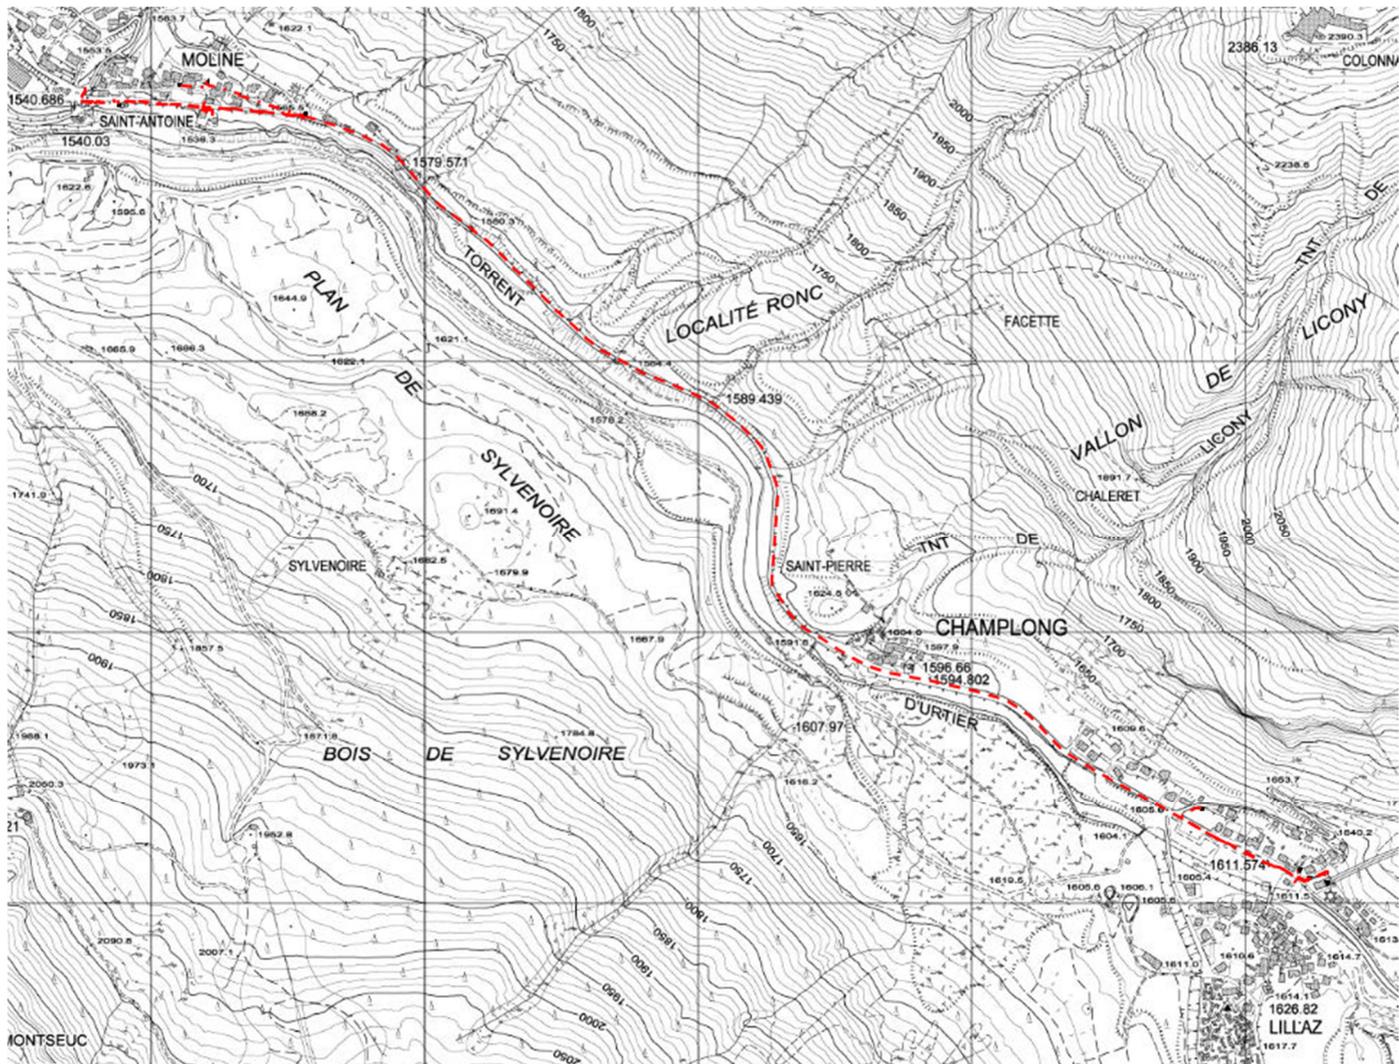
Planimetria dell'intervento con ubicazione del nuovo tratto di linea interrata in progetto (tratto rosso) ubicato nel tratto di fondovalle tra Cogné e Lillaz.
